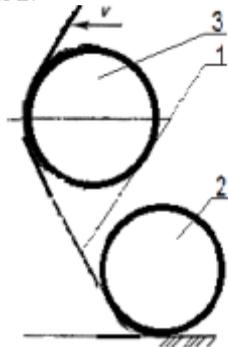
Схема уплотнения грунта обечайкой в форме вертикального эллипса
